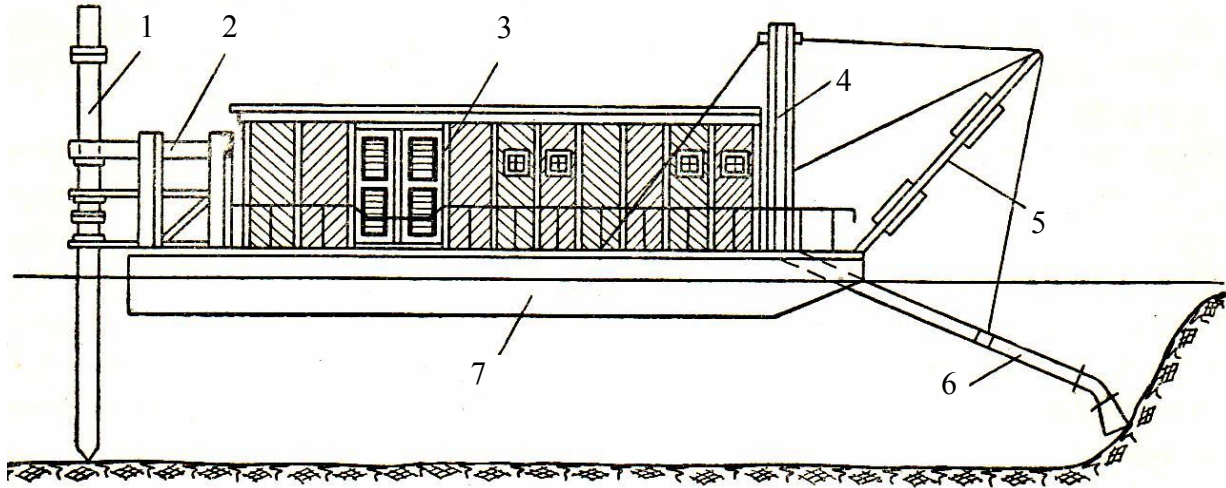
Плавучий землесосний снаряд (вигляд збоку): 1 – палі; 2 – фундамент апарату; 3 – палубна надбудова; 4 – портална рама; 5 – стріла; 6 – усмоктувальна труба; 7 – металевий понтон
